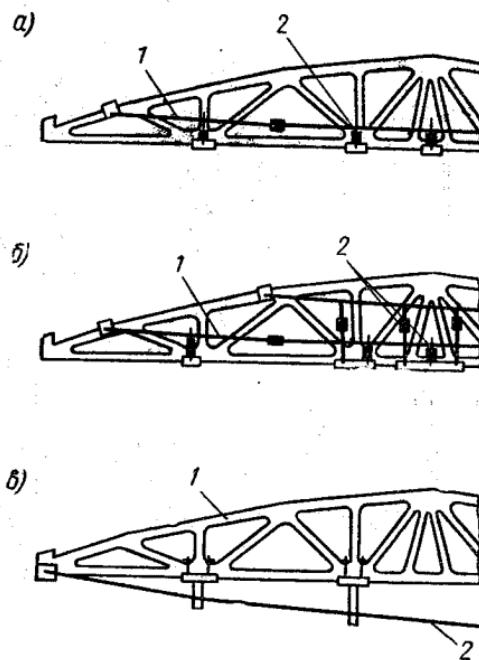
Усиление ферм шарниро-стержневыми цепями:
